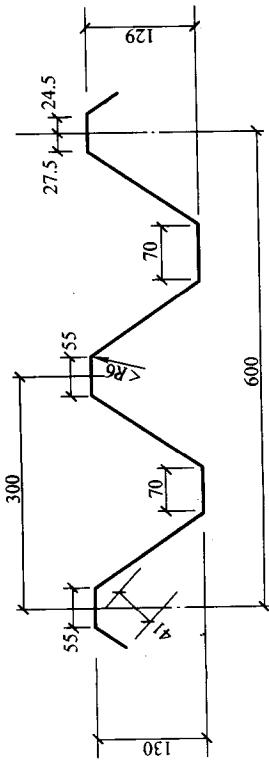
2 YX130 - 300 - 600 压型钢板外形尺寸
